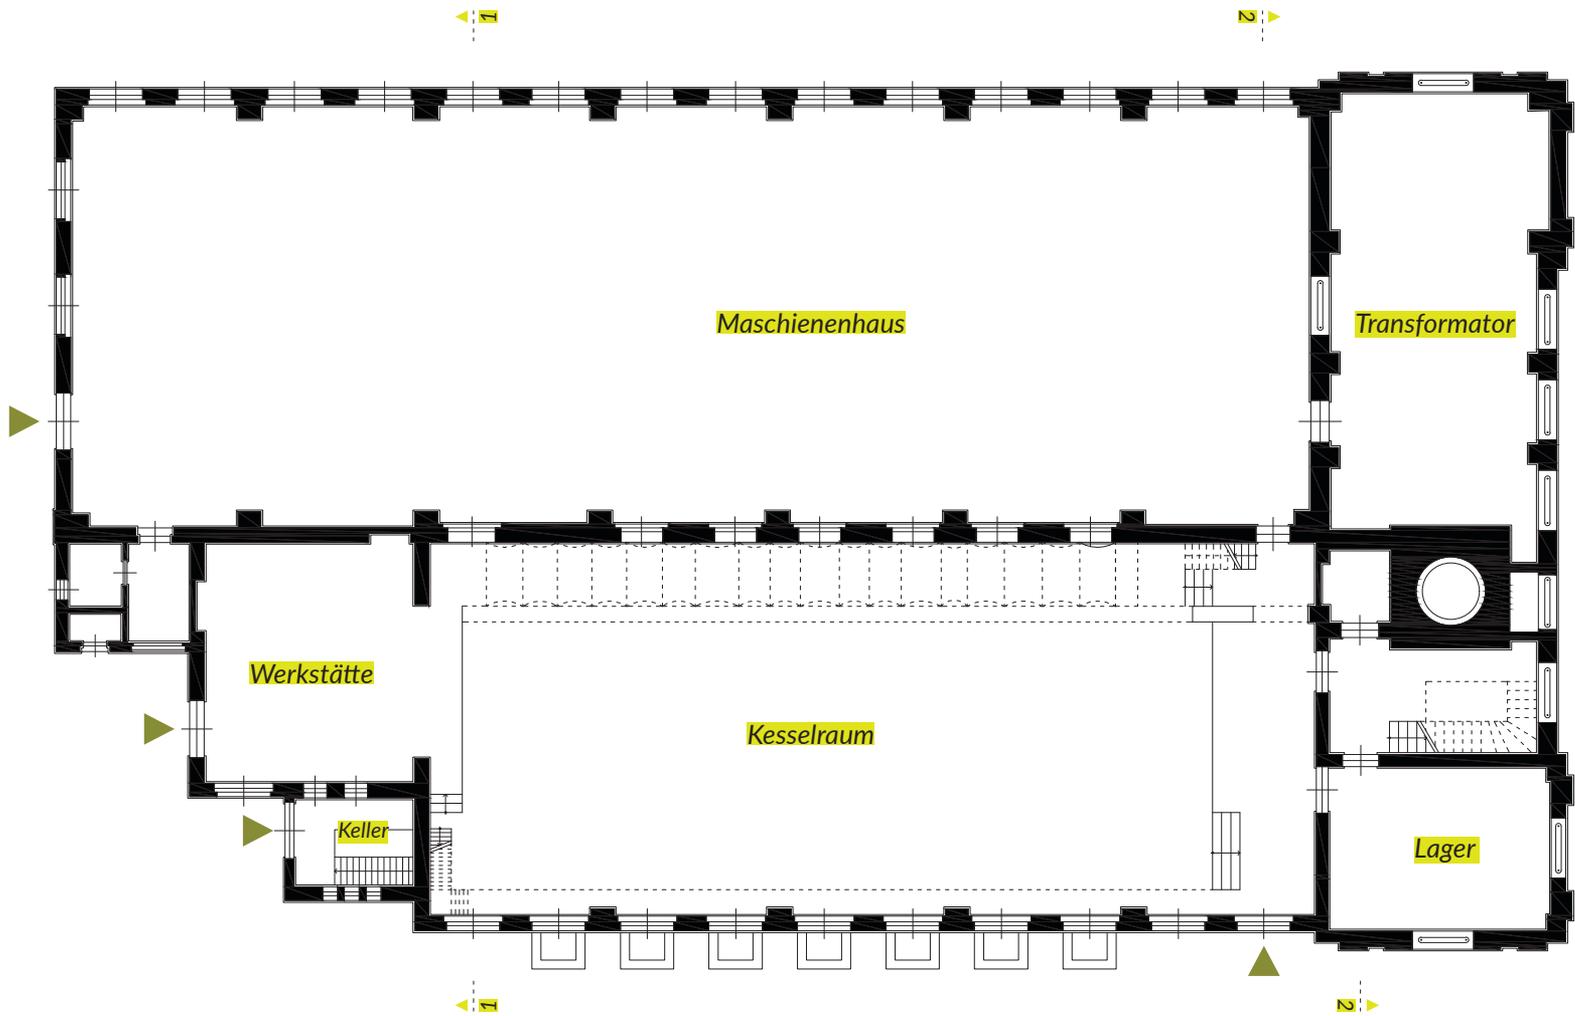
Grundriss Elektrizitätswerk M 1:250 (Stand 1903)
